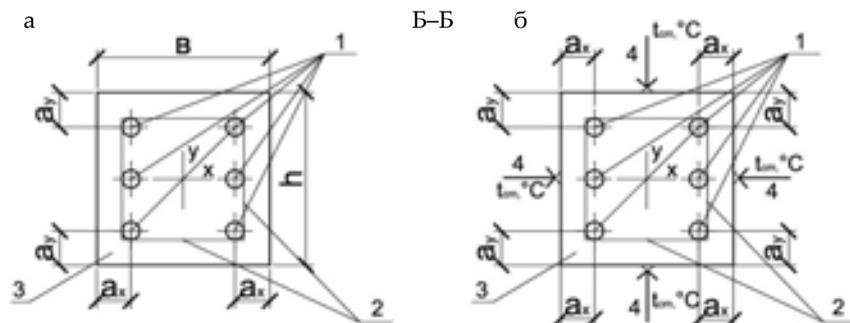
Расчетная схема растянутого железобетонного пояса (сечения Б-Б) при оценке:
